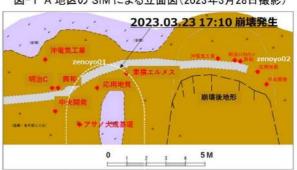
設置平面位置図(白点線の箇所が崩壊箇所)
